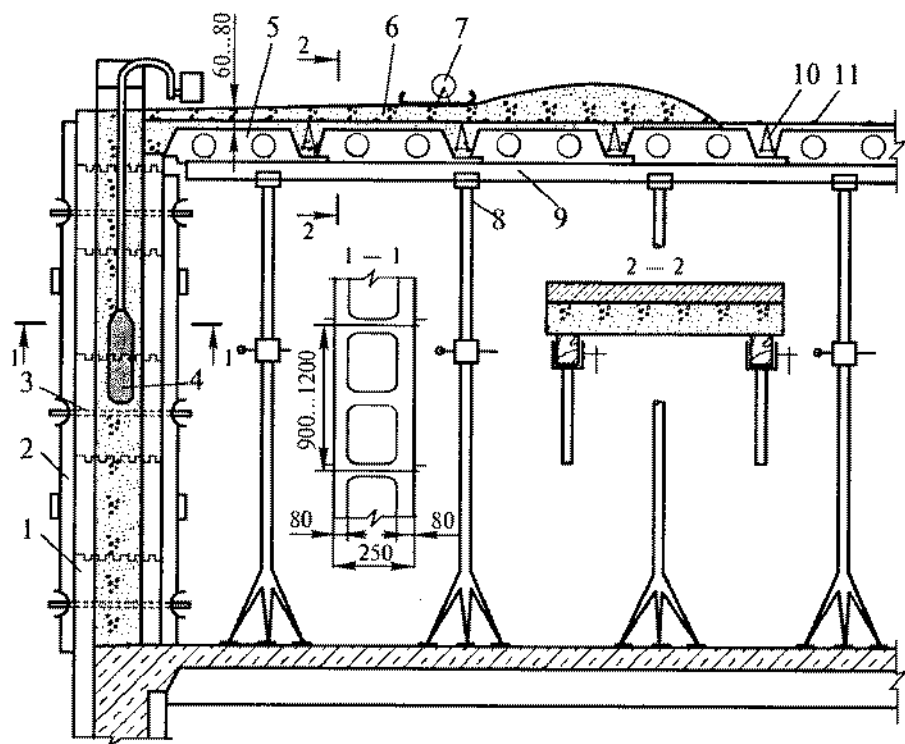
Схема устройства наружных стен и перекрытий в несъемной опалубке:
